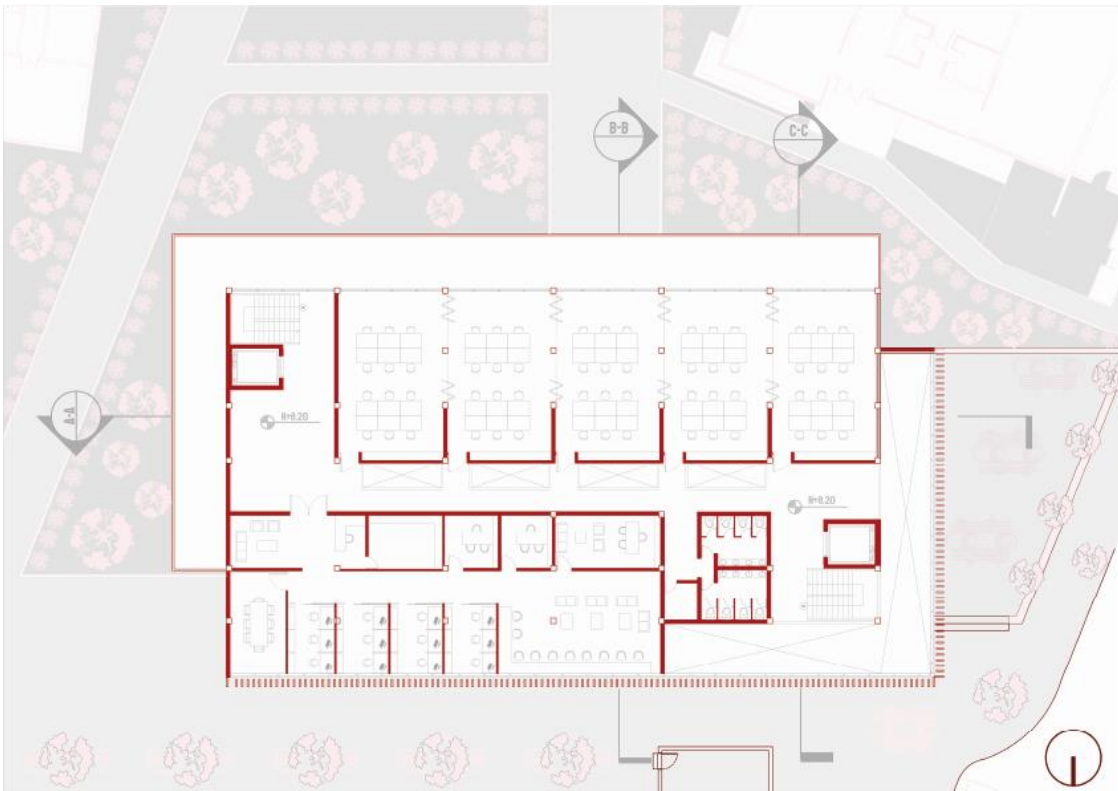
Planta Alta 2 N+8.20. Ilustración del autor
